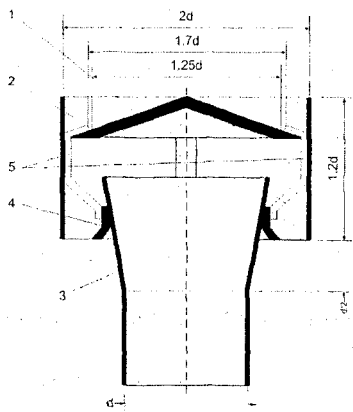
Схема дефлектора типа ЦАГИ: 1 — колпак; 2 — обечайка; 3 — диффузор; 4 — конус; 5 — лапки, удерживающие колпак и обечайку
